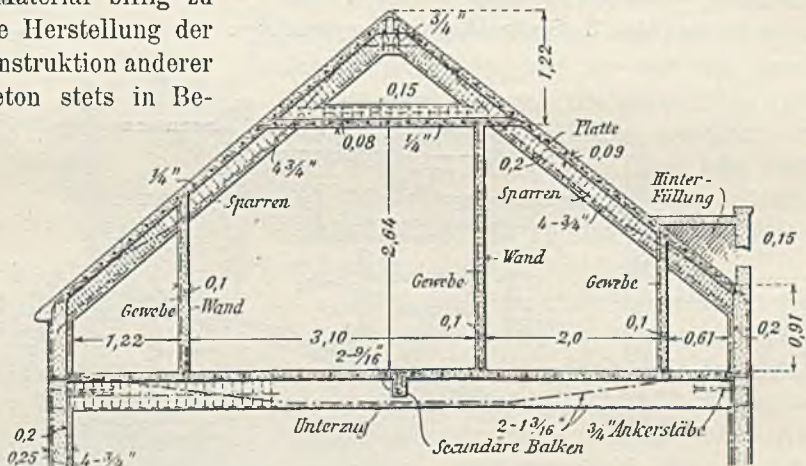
Stallgebäude. Schnitt durch das Dachgeschoß.
